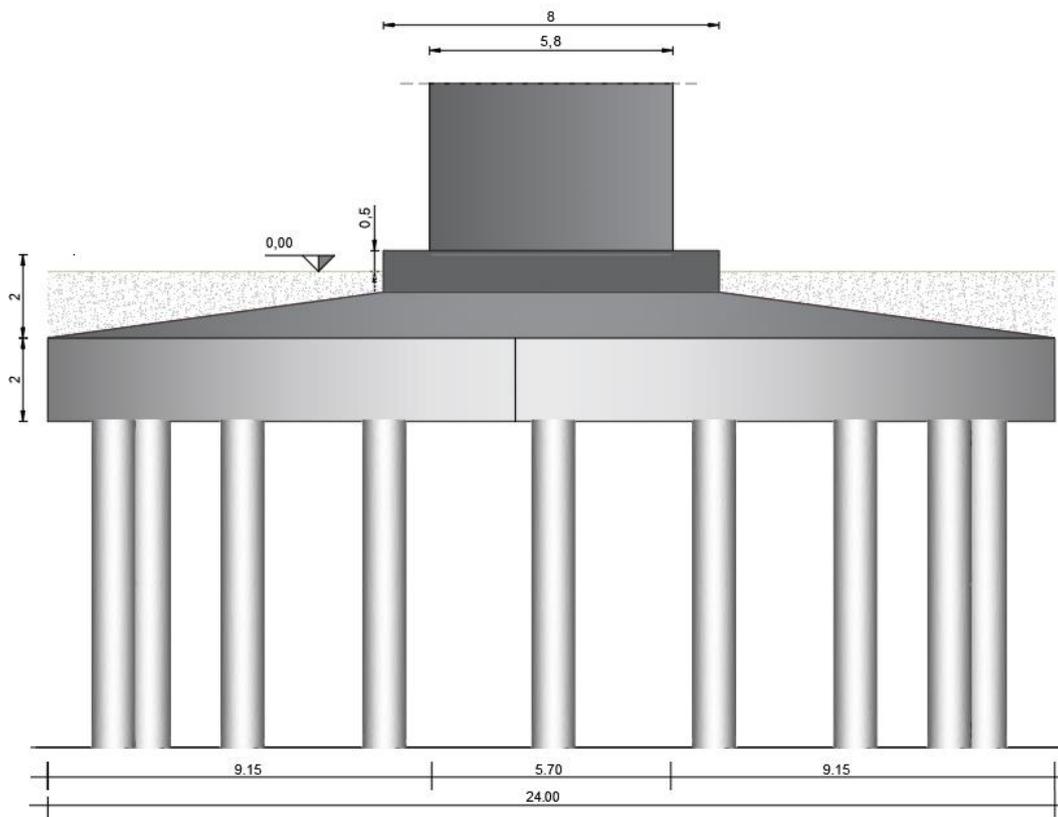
Schema geometrico di riferimento della struttura di fondazione.
